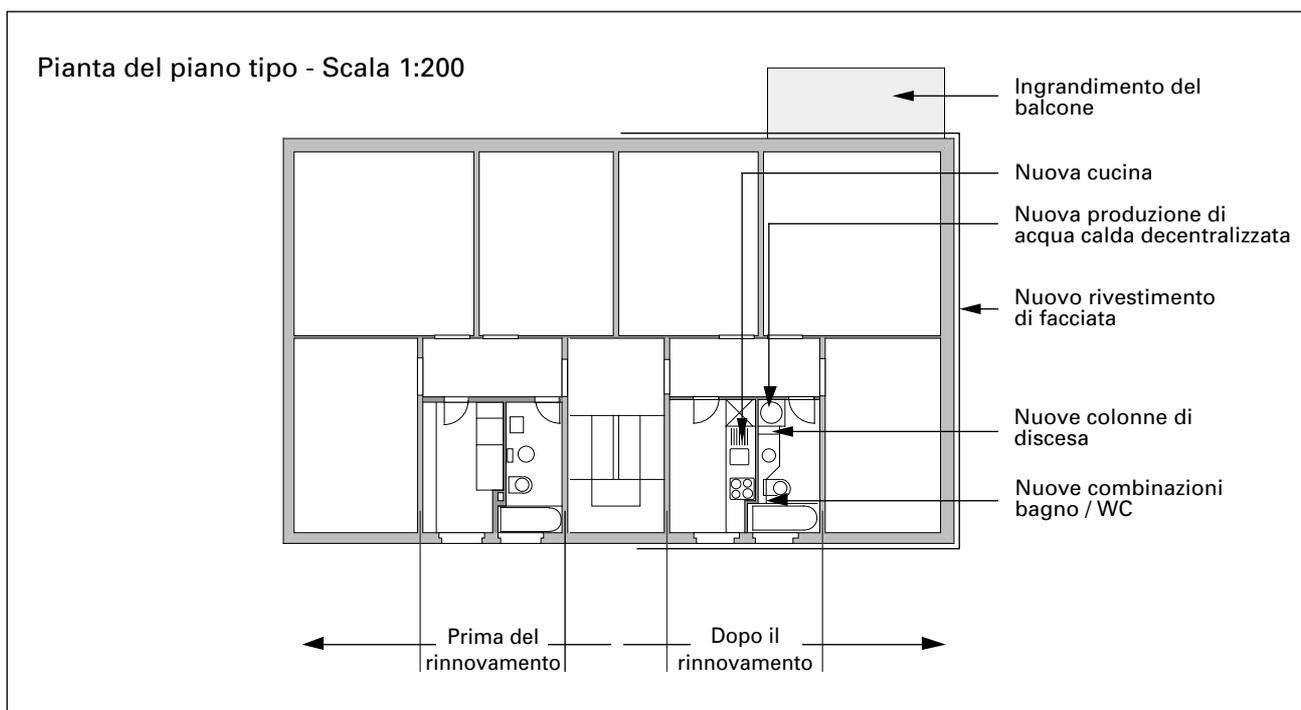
La pianta mostra le modifiche realizzate all'interno e all'esterno dell'immobile.
